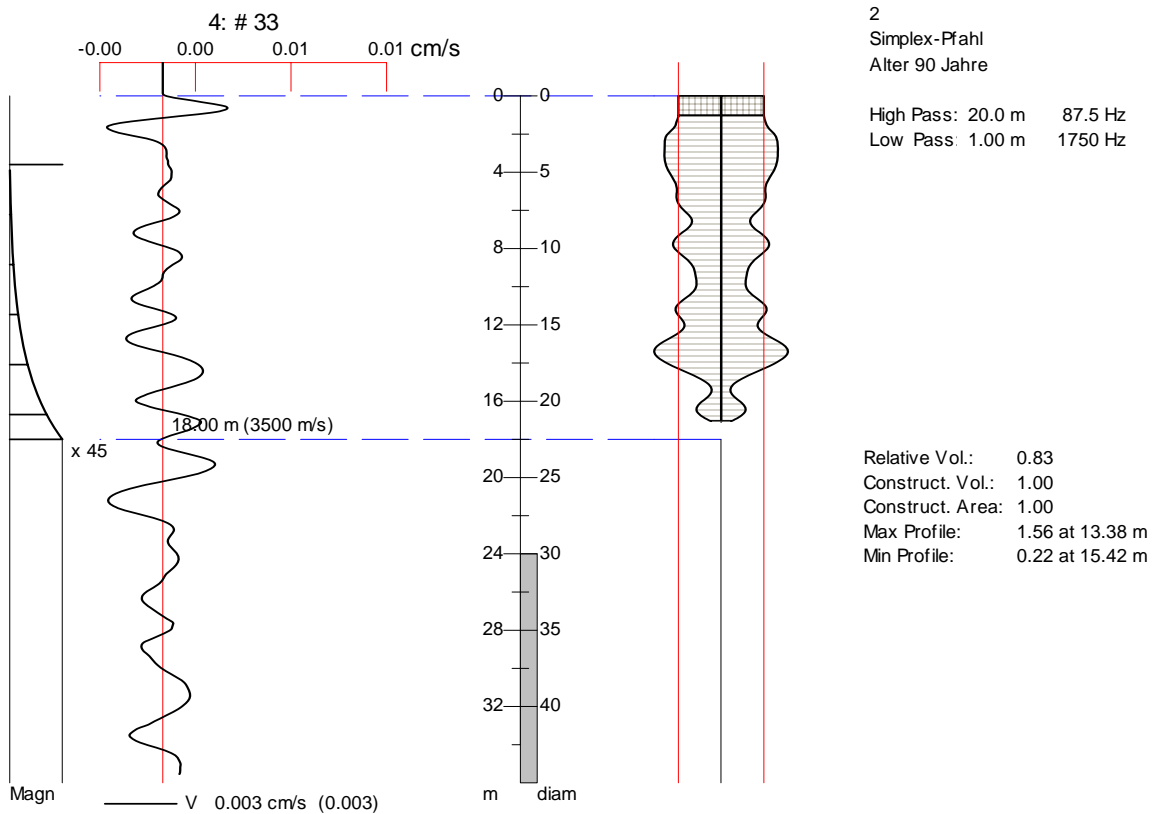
Testpfahl an der Südostecke mit zweifelhafter Betonsäule
